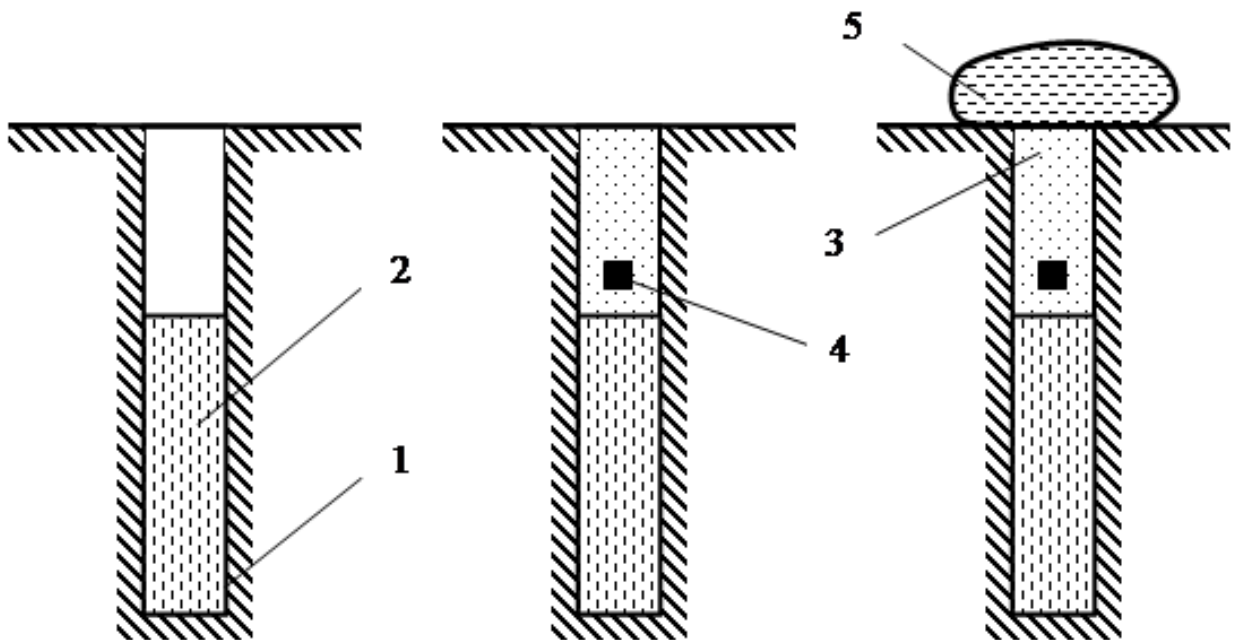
Схема конструкції гідрозабивки вибухової свердловини:
